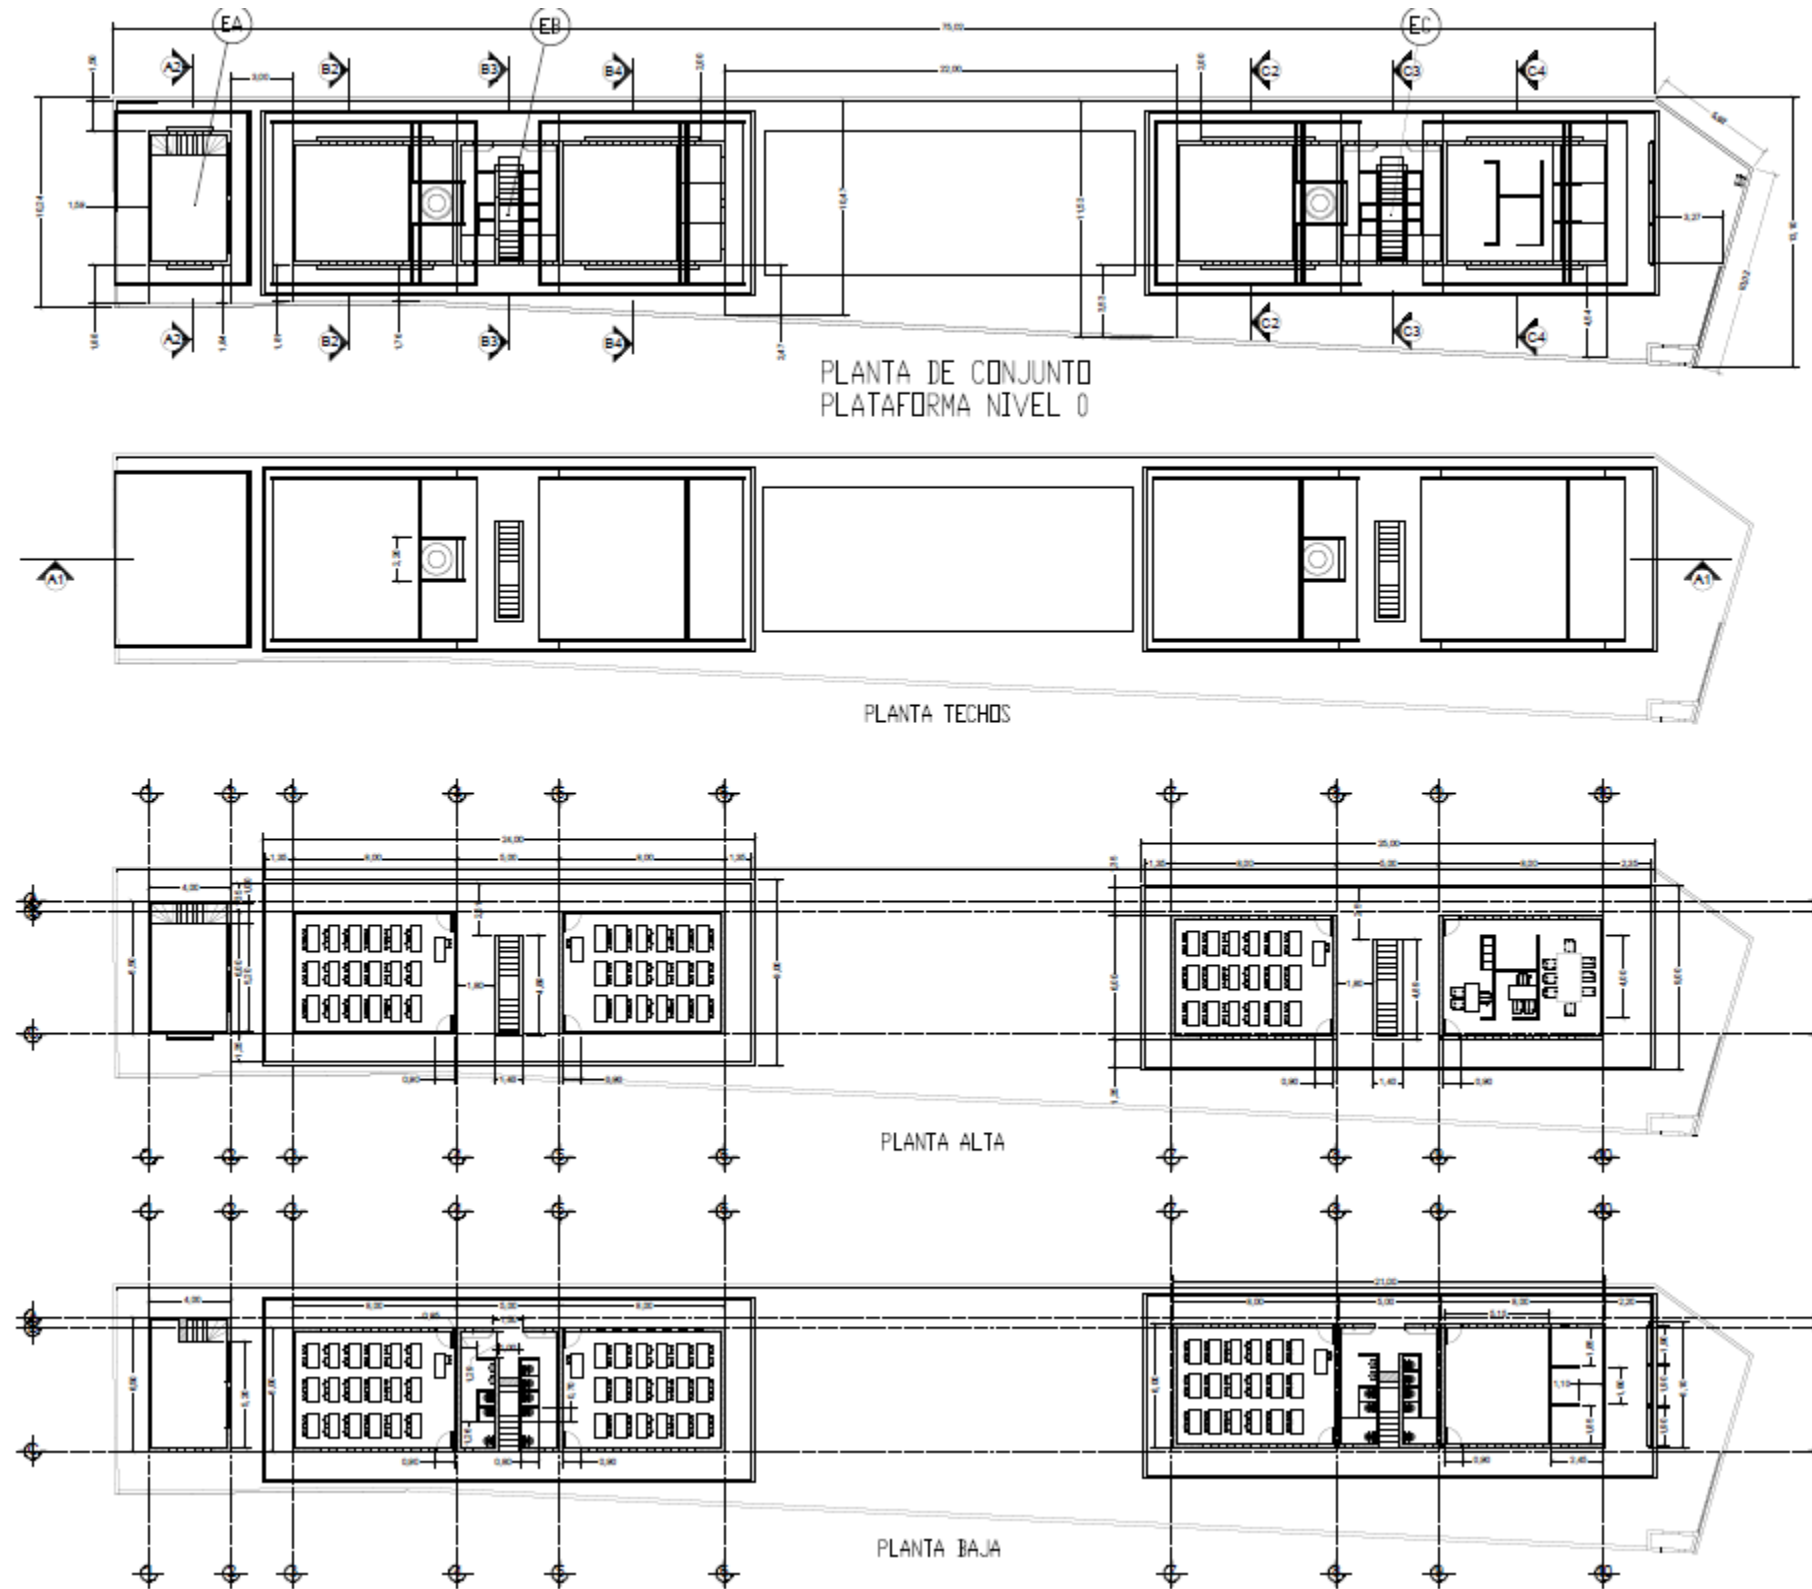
Plano-Plantas arquitectónicas. Fuente: Elaboración propia
